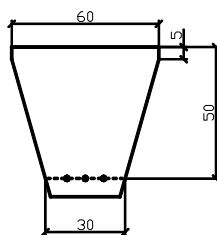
Прямоугольное сечение со скошенными краями внизу
